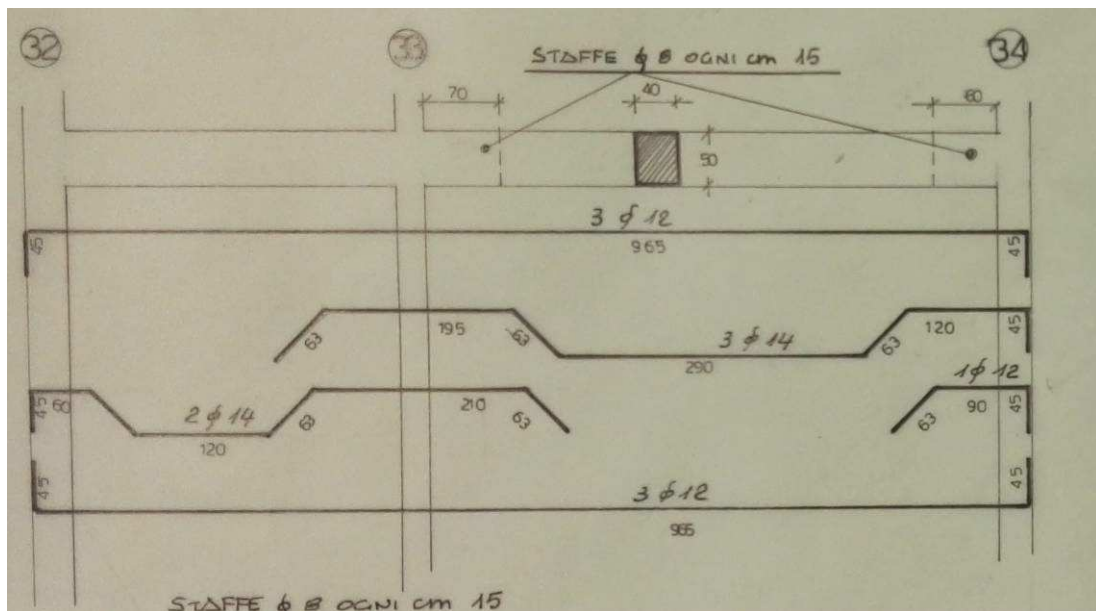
Stralcio del progetto esecutivo reperito Padiglione n.16. – Particolari armature trave 32-34 I impalcato Zona B
